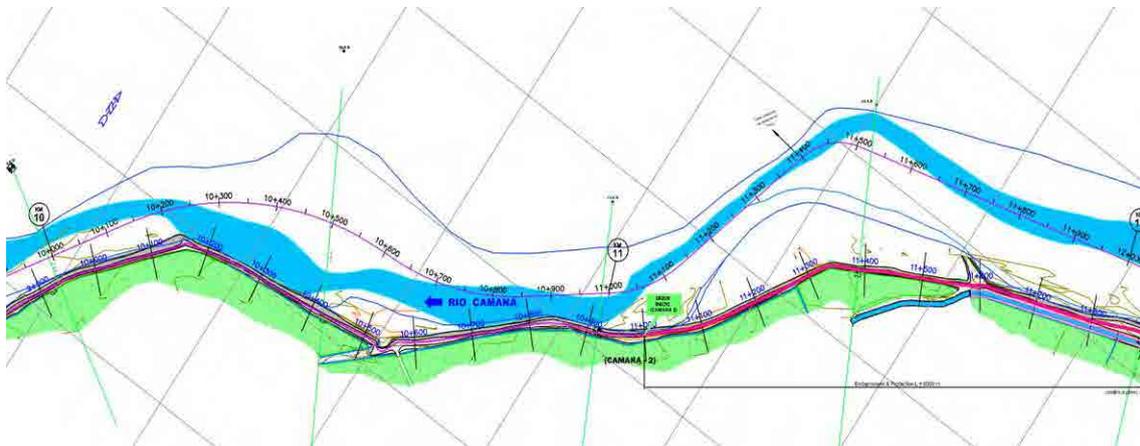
Planta de instalaciones Caman-3 (2)
